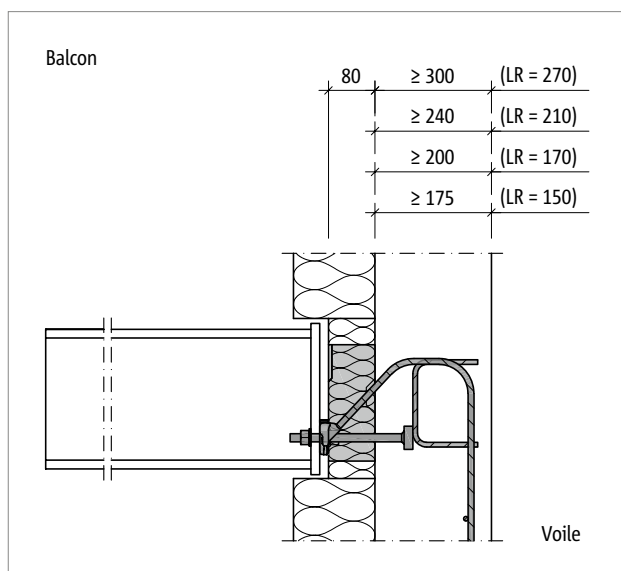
Schöck Isokorb® T type SQ-WU-V1 : structure spéciale pour raccordement mural
